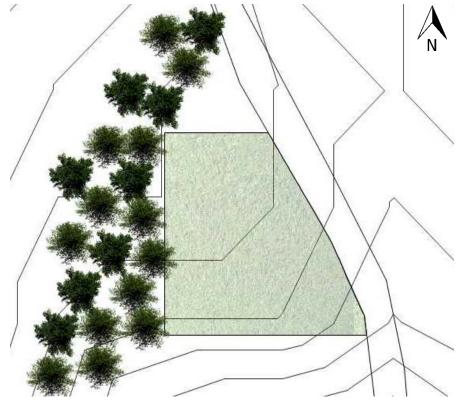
Levantamento planialtimétrico. Fonte: AUTORA, 2019.
